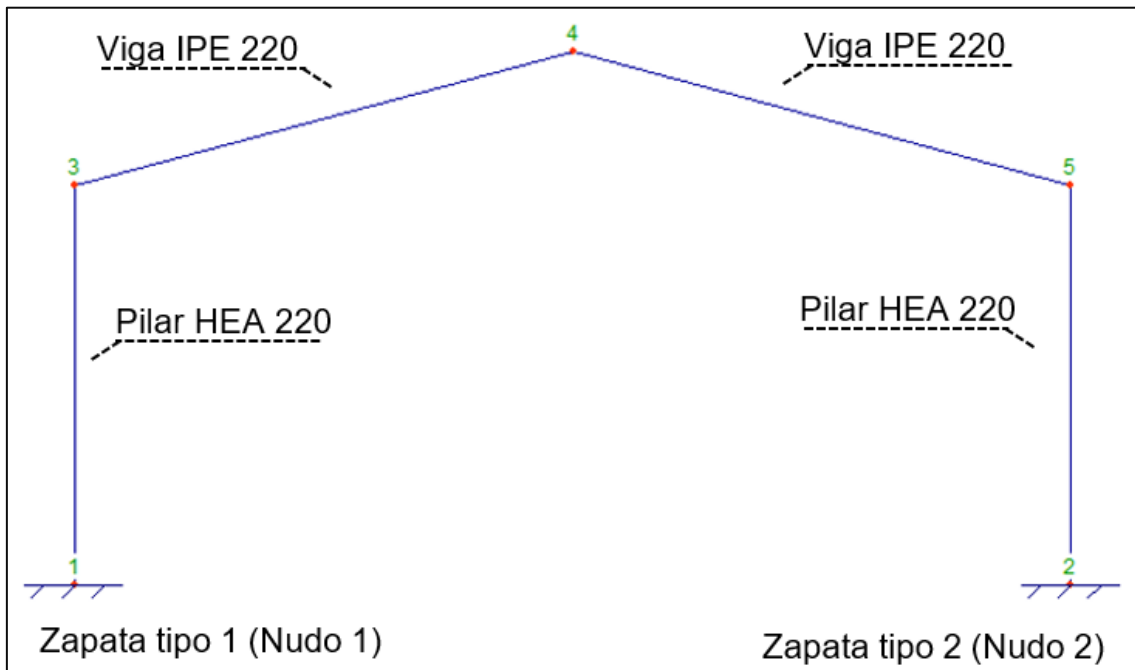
Detalle del tipo de zapata y del perfil de acero de cada elemento de la estructura metálica de los pórticos de la nave. Fuente: Metalpla XE 64
